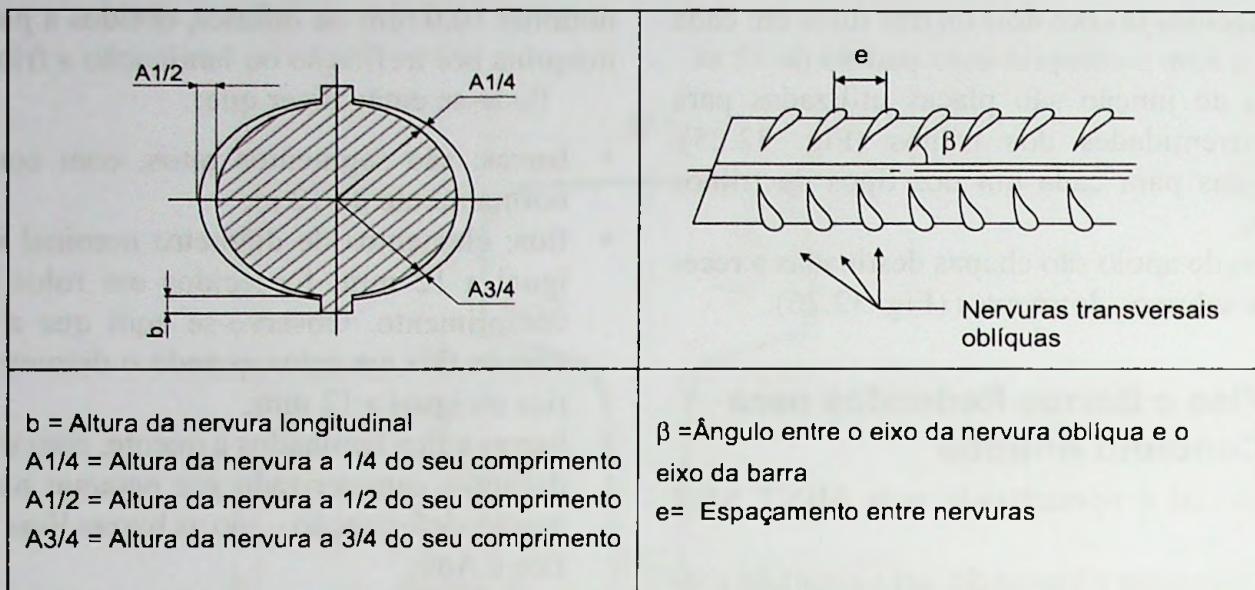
Exemplo de configuração geométrica com nervuras transversais oblíquas em dois lados da barra e nervuras longitudinais.
